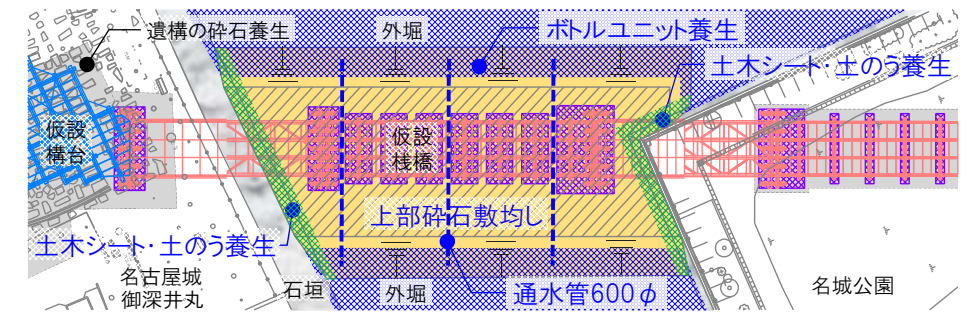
仮設棧橋とボトルユニットによる外堀養生(平面図)
